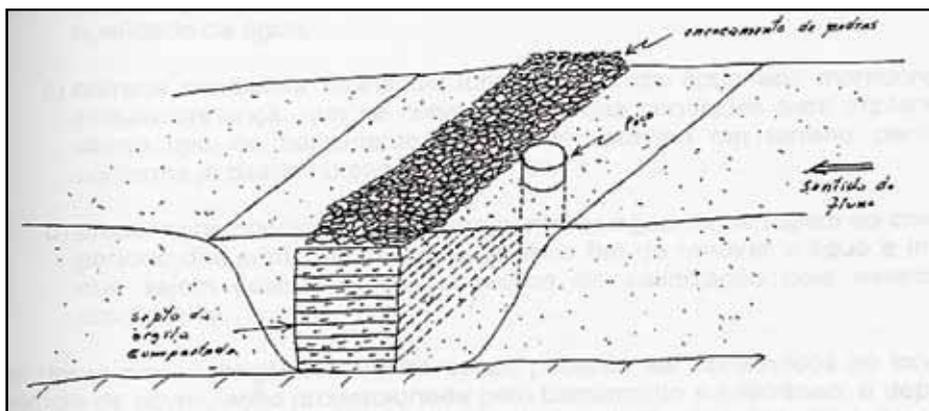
Construção do Septo Impermeável com Argila Compactada
